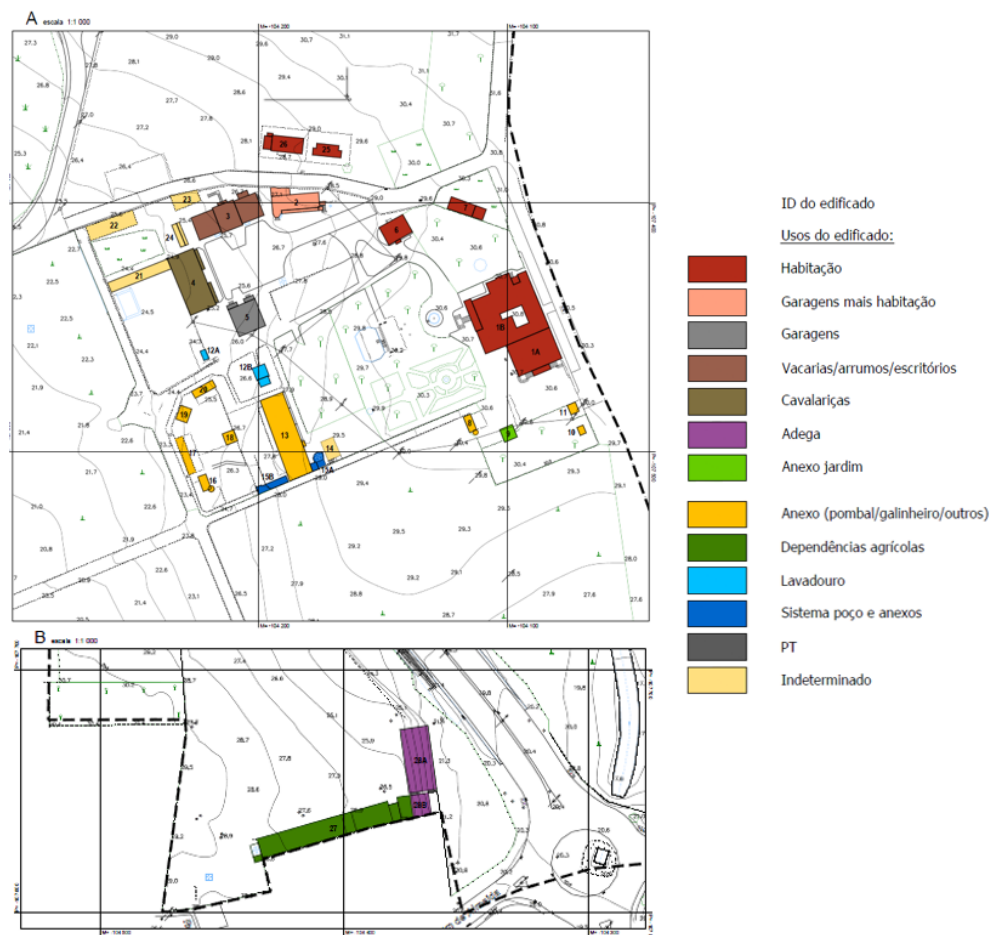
Planta de edificado existente na Quinta do Barão e seu tipo de uso (adaptado de NRV, 2021a)
